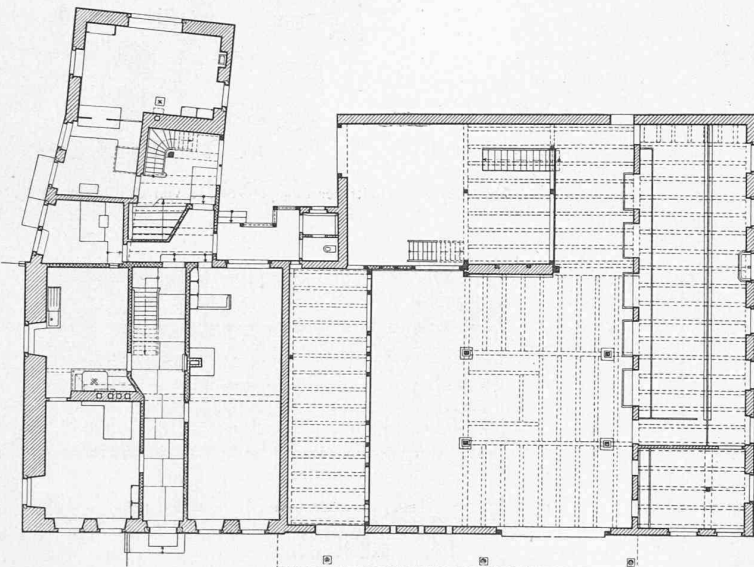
Grundriss vom Erdgeschoss. — Masstab 1 : 300 (Originalpläne 1 : 100).
